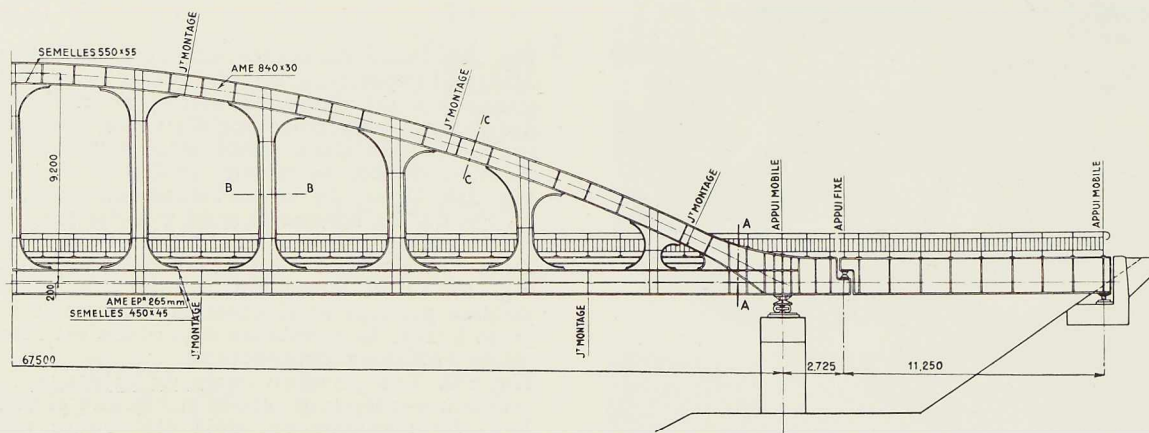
Demi-élévation comprenant la travée d'approche de 13^m97.
